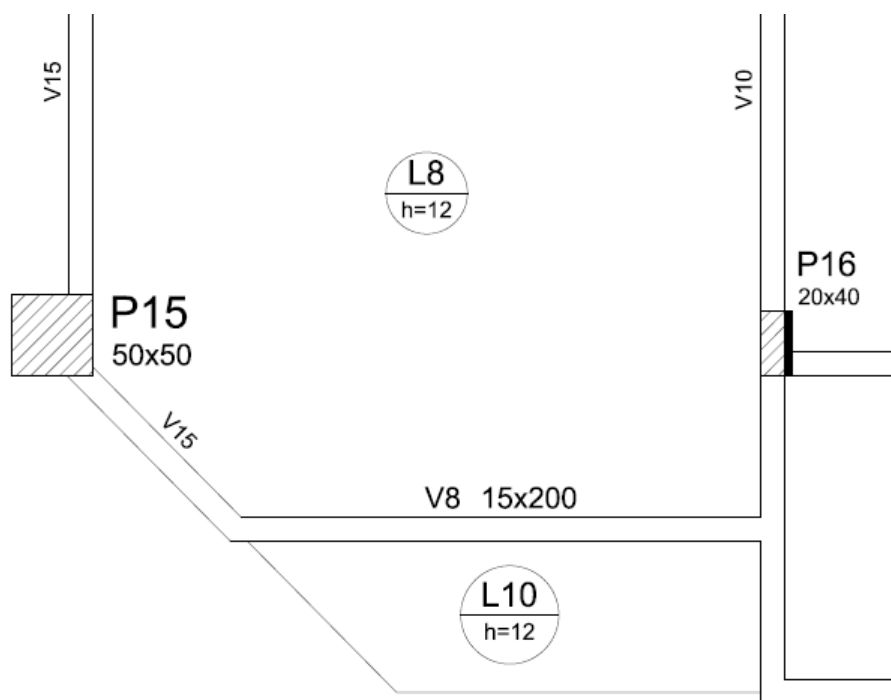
Canto da forma do pavimento - P15 seção 50x50
